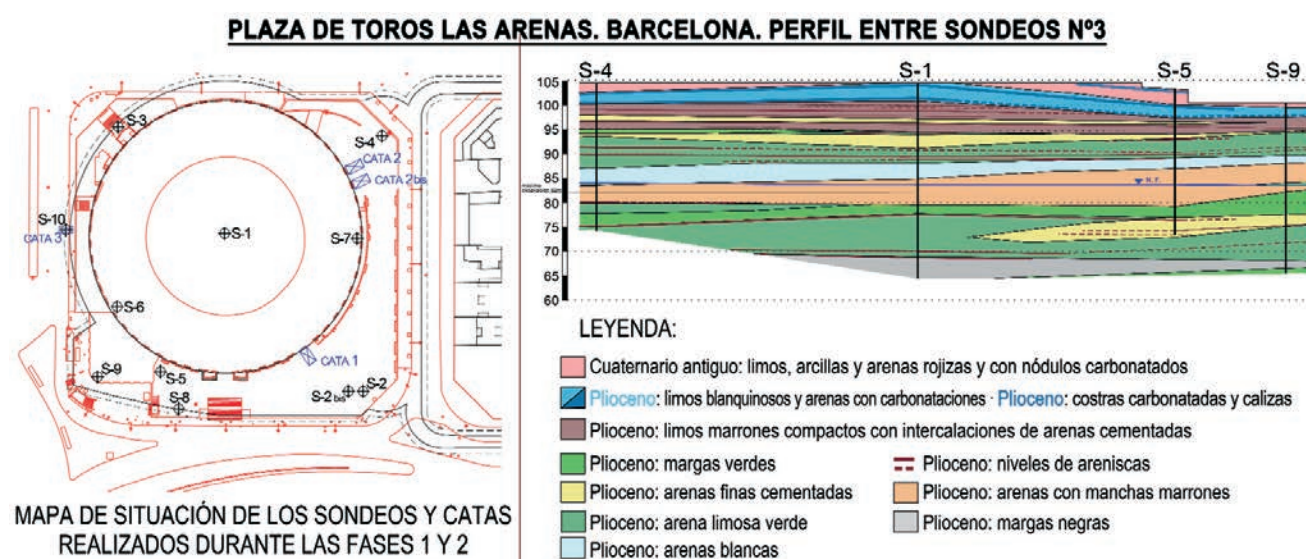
Emplazamiento de los sondeos y perfil geotécnico tipo
